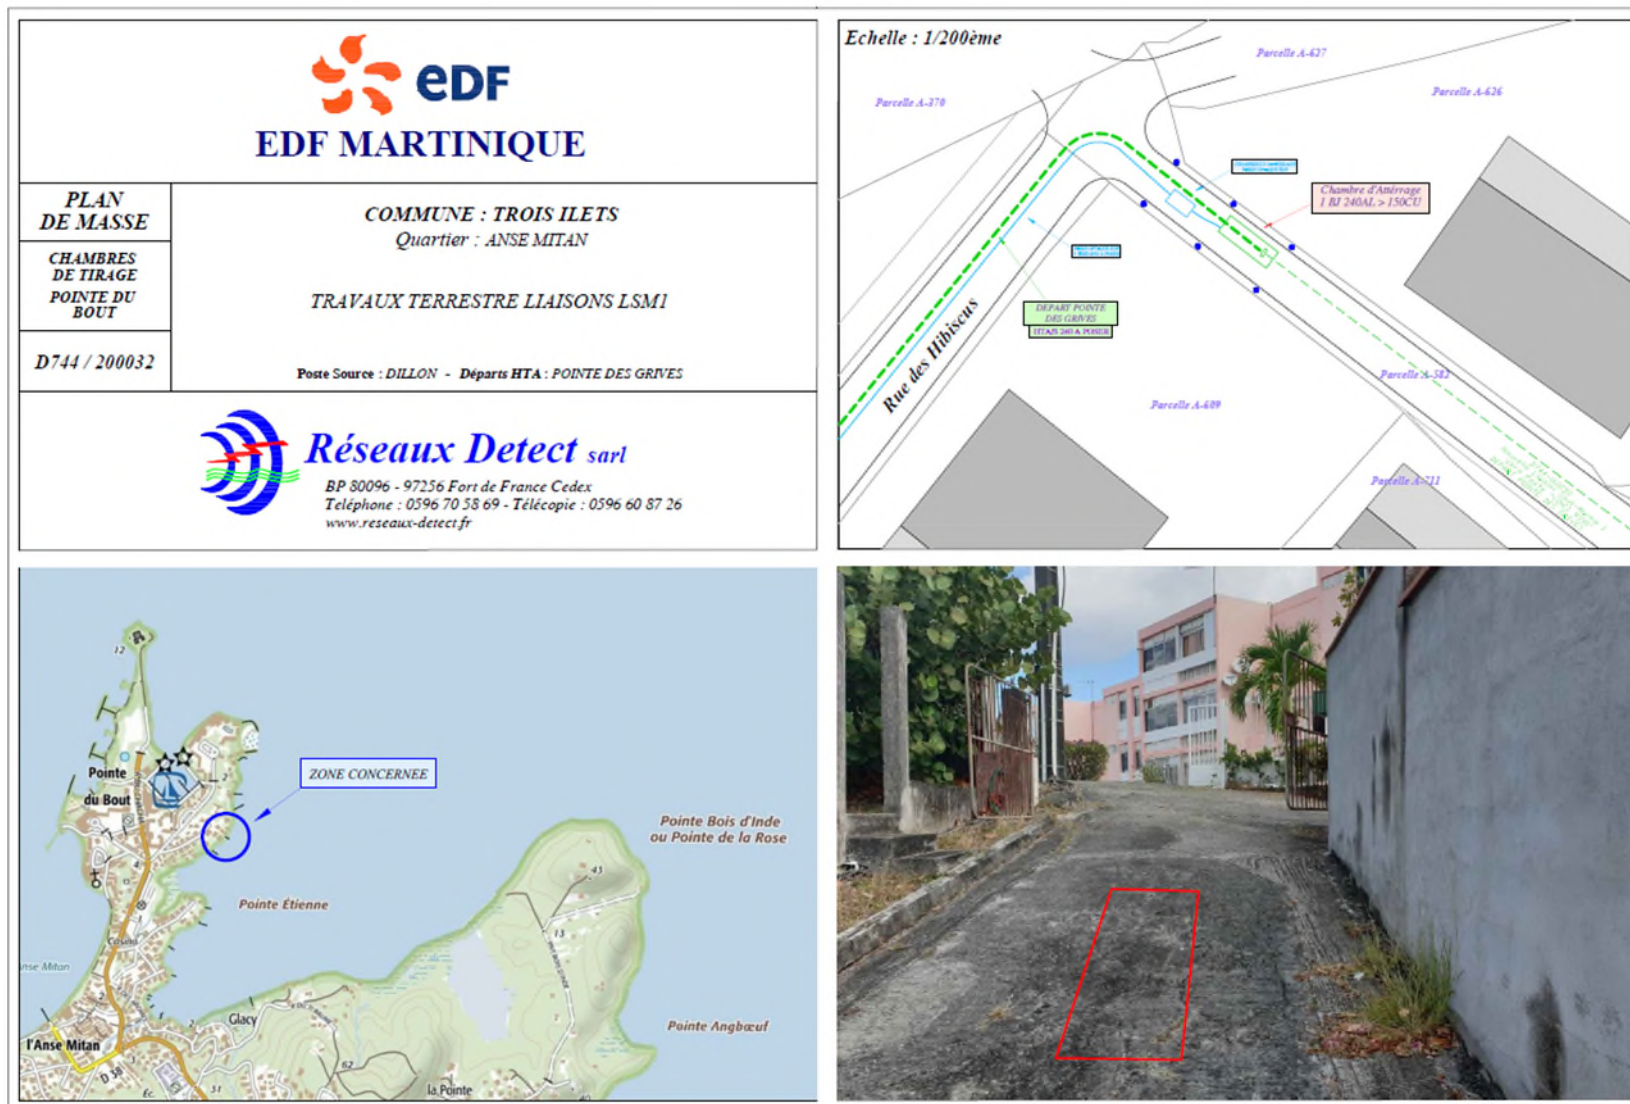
PLAN MASSE DE LA ZONE D'ATERRAGE DE LA POINTE DU BOUT
